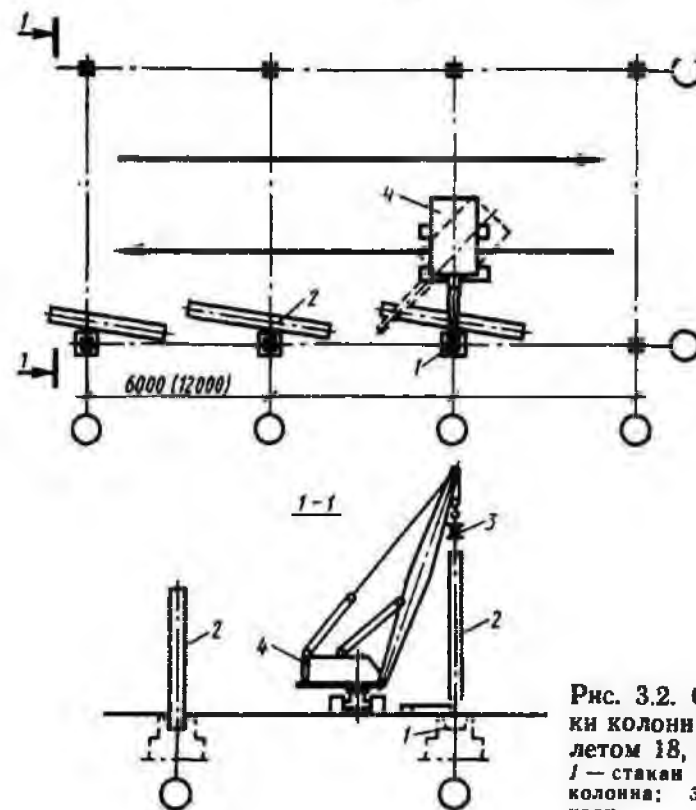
Схема установки колонн в зданиях пролетом 18, 24 и 30 м:
